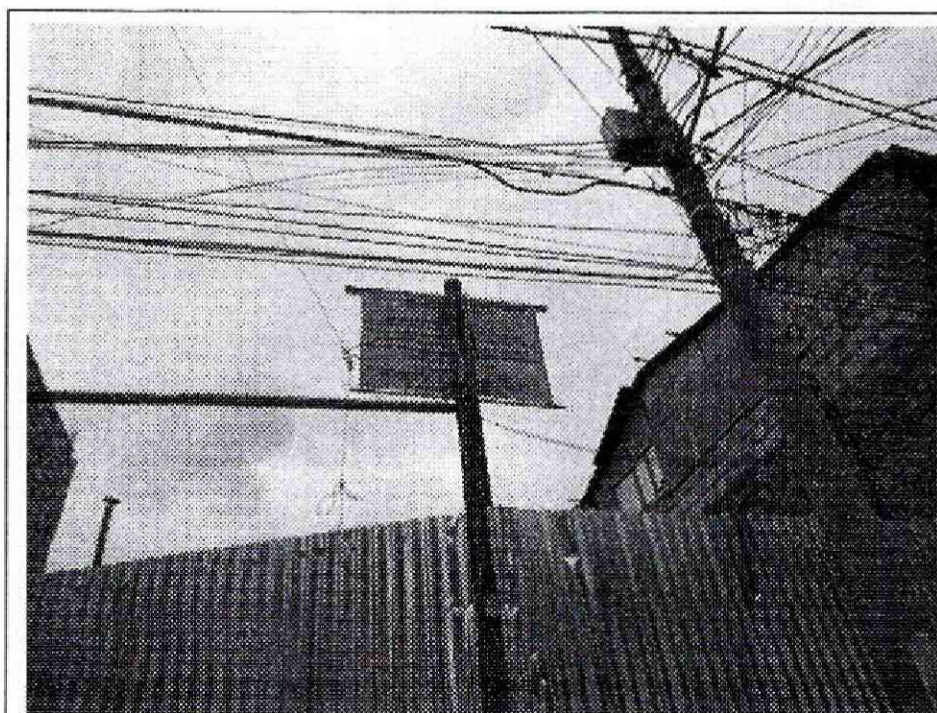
Vista general de una fracción de la fachada del predio de la Calle 78 No. 69-54, donde se adelantan actualmente actividades de obra.
